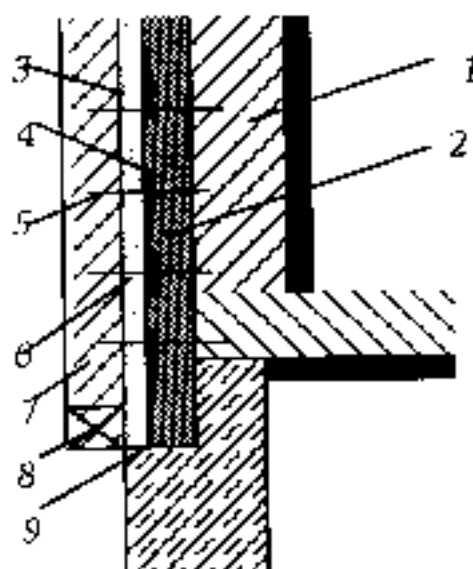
1 - кладка несущей стены; 2 - слой пенополистирола; 3 - воздушная прослойка; 4 - прижимная шайба; 5 - проводящий анкер; 6 - теплозащитный экран; 7 - облицовочная кладка; 8 - вентиляция; 9 - гидроизоляция
